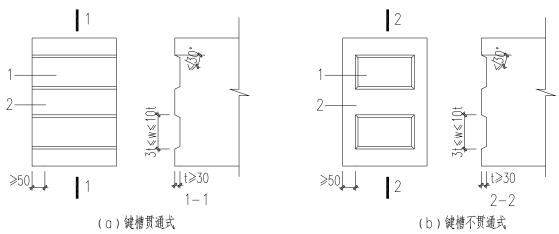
预制梁端键槽构造示意图 1-键槽 2-梁端面
